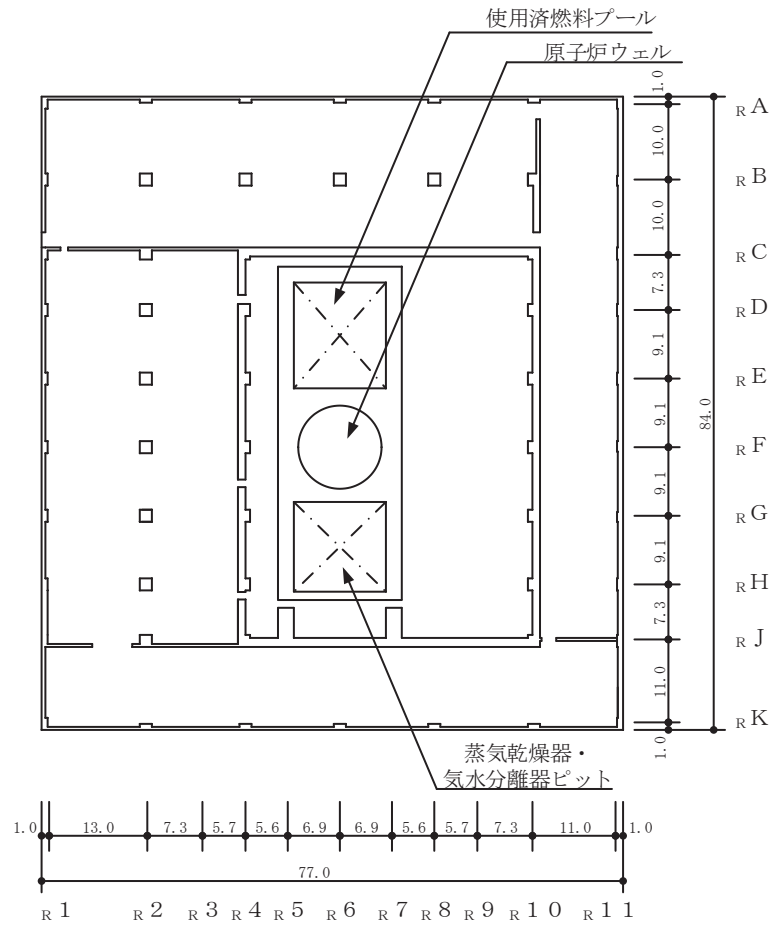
使用済燃料プールを含む原子炉建屋の概略平面図 (0. P. 33. 2m)
